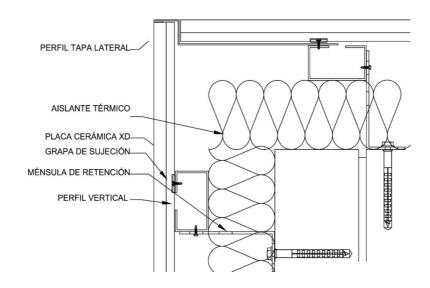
SECCIÓN HORIZONTAL - ESQUINA EXTERIOR CON CANTO PILASTRA
